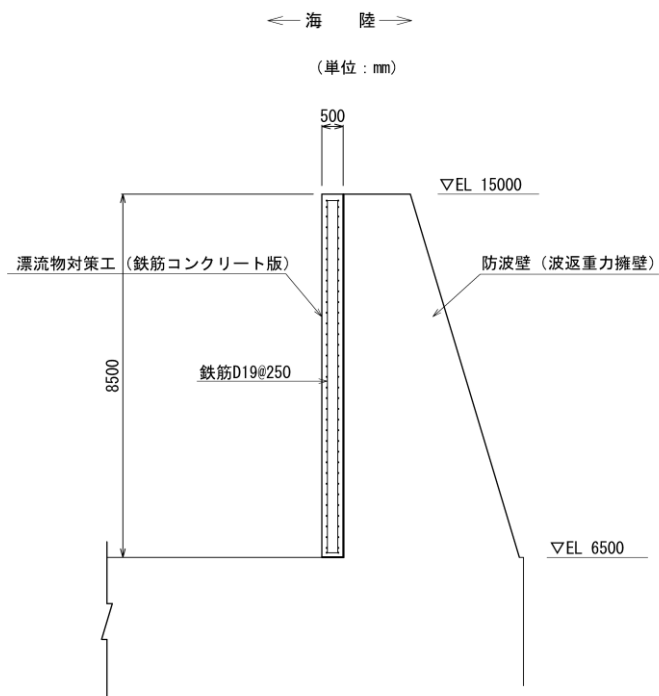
(2) 防波壁 (波返重力擁壁) 重力擁壁における漂流物対策工 (鉄筋コンクリート版) の概略配筋図 (断面図)
